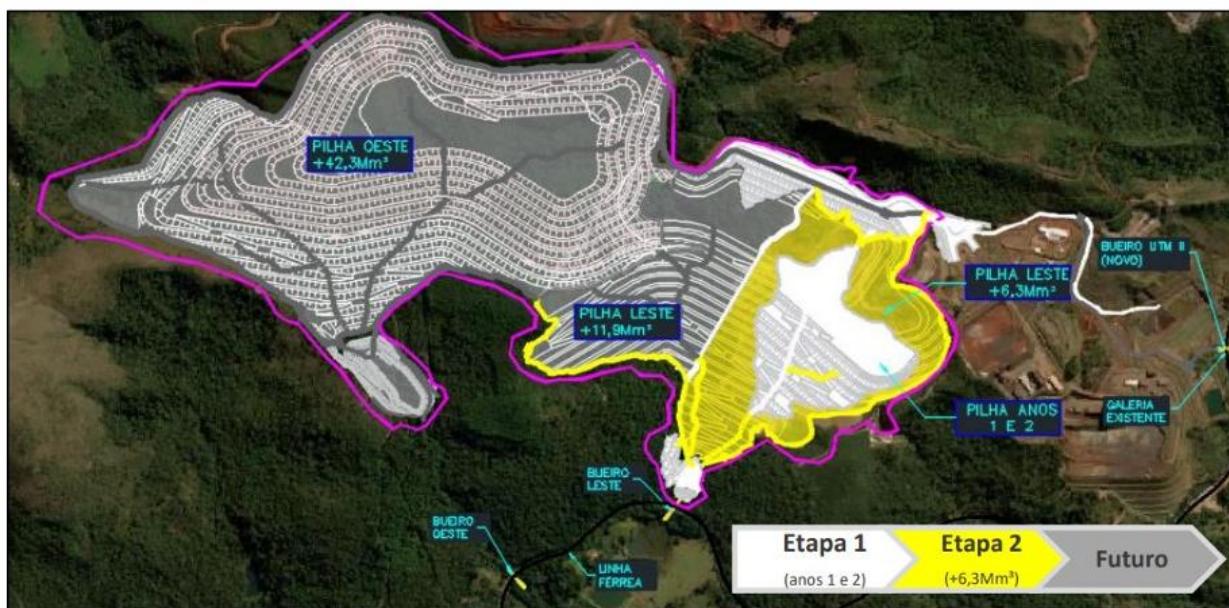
Localização da operação etapa Leste da Pilha MB2
